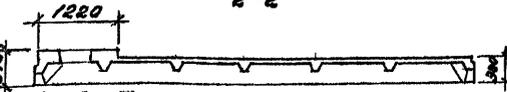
ПЛИТА ДЛЯ ЛЕГКОСБРАСЫВАЕМОЙ КРОВЛИ
